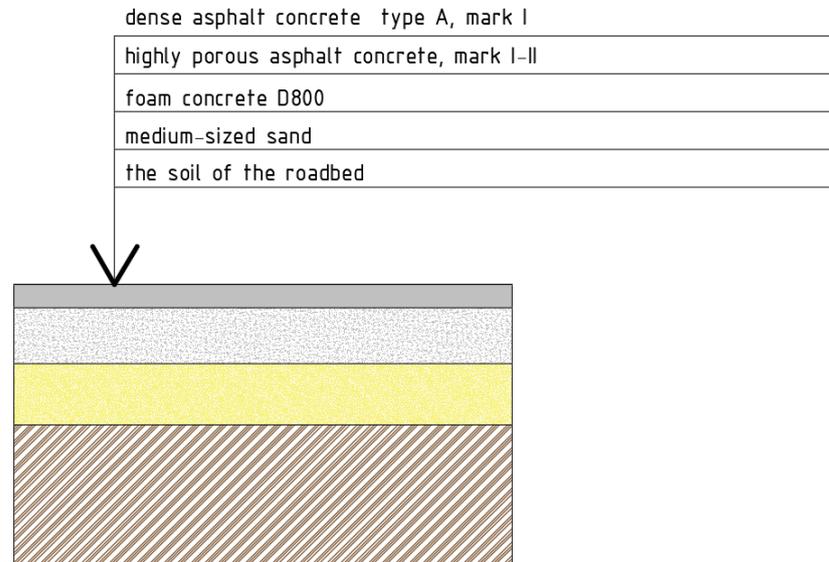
Конструкция дорожной одежды с несущим основанием из пенобетона
